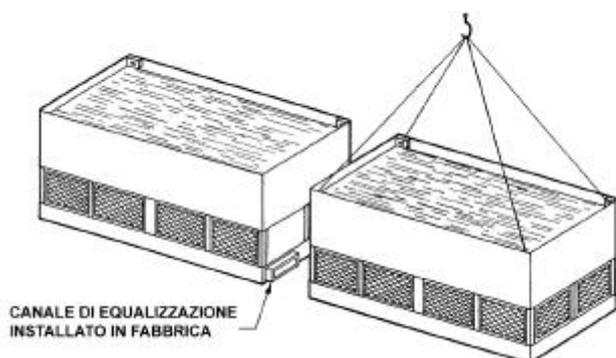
Dettaglio sollevamento e posizionamento canale di equalizzazione
